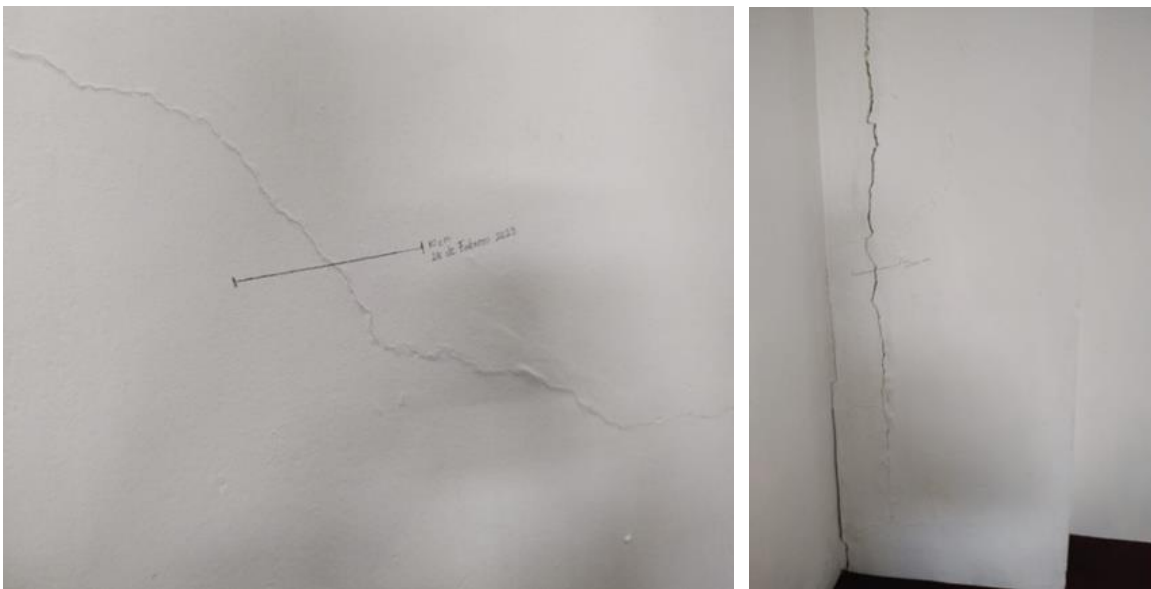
Toma de testigo en fisuras o grietas, Fuente: Propia
